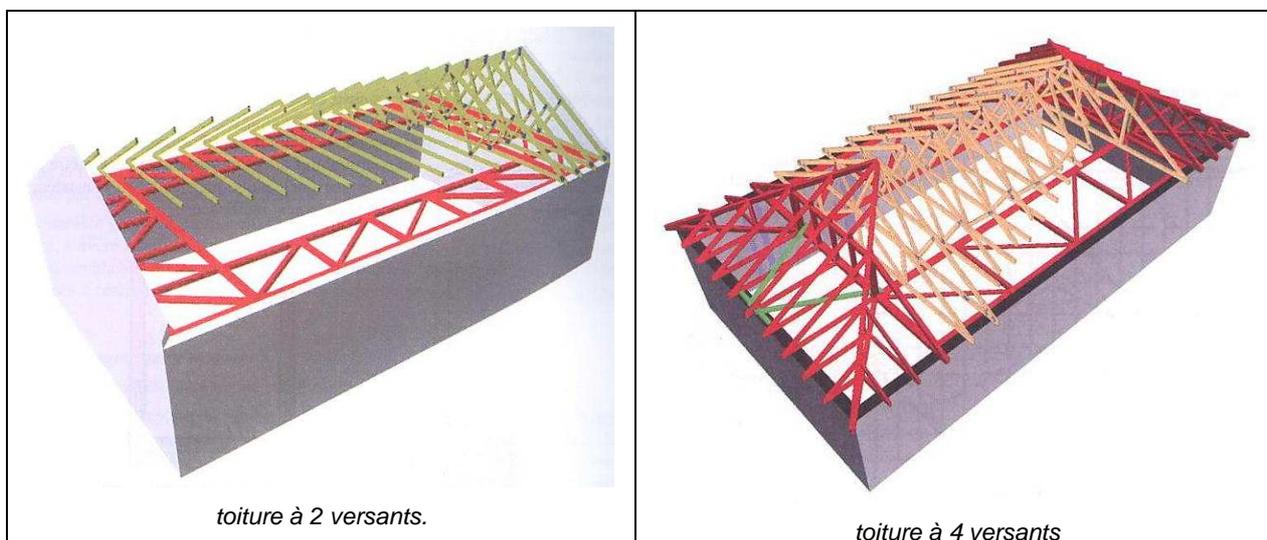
Contreventement d'une toiture à fermettes sous entrain par poutre au vent. (Document AFPS).
